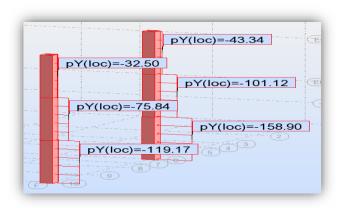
chargement des poteaux de rives et intermédiaires
